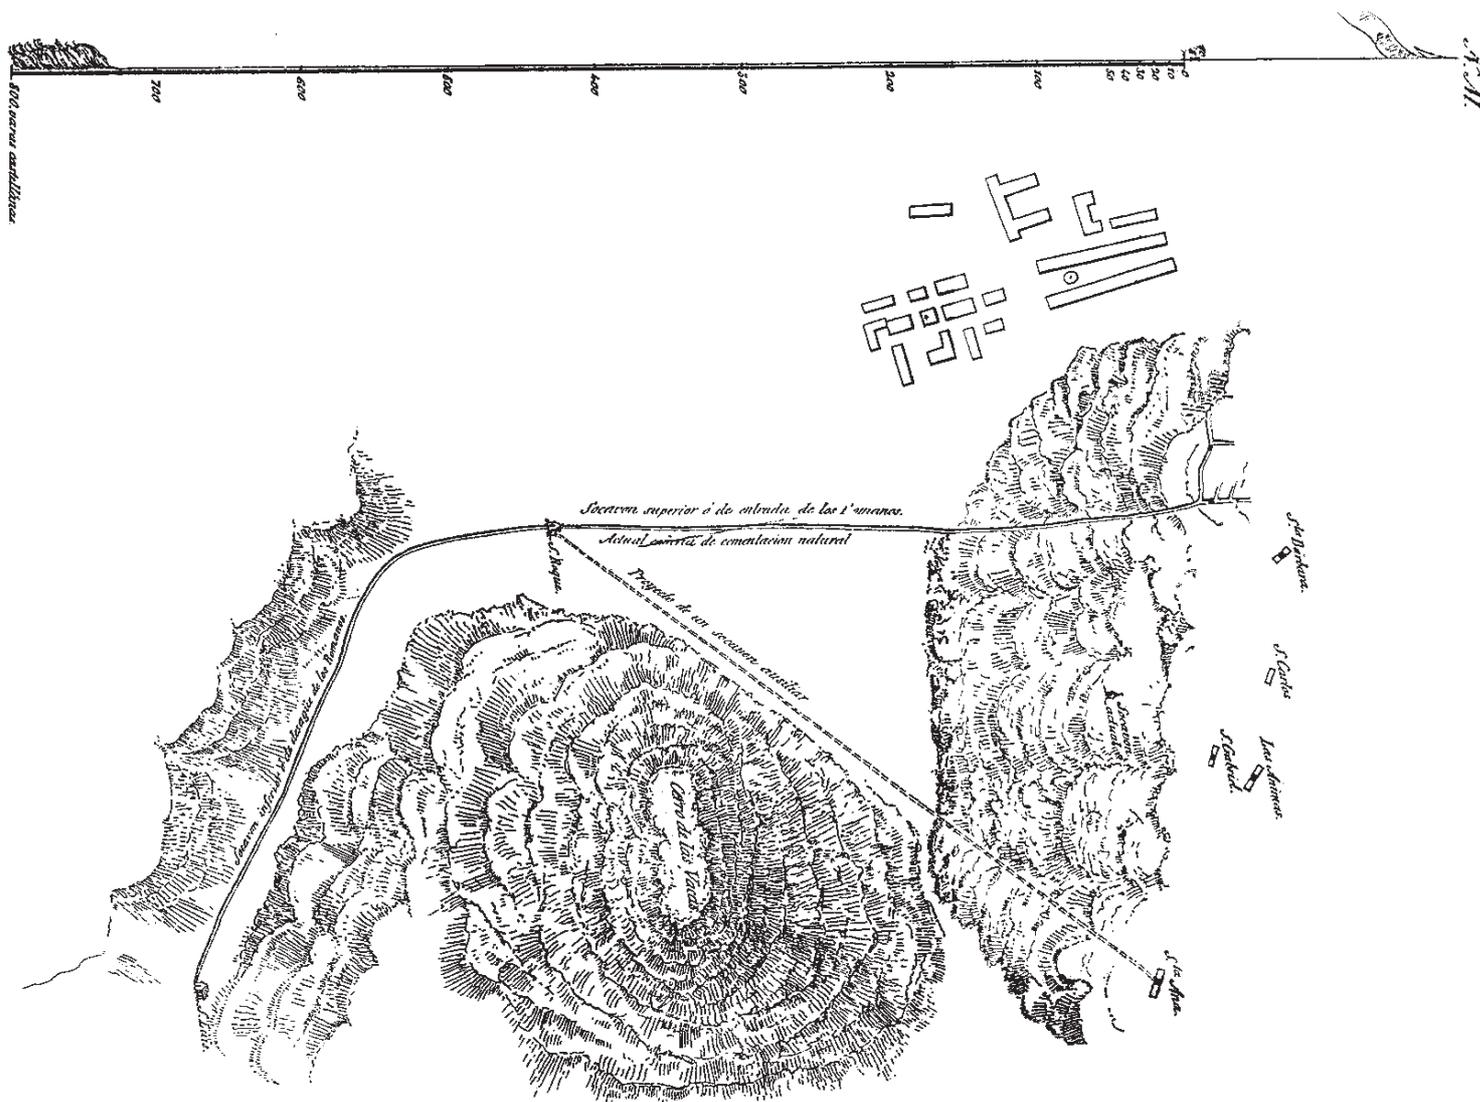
Plano topográfico levantado en 1828. Según Ezquerro del Bayo (1852)
